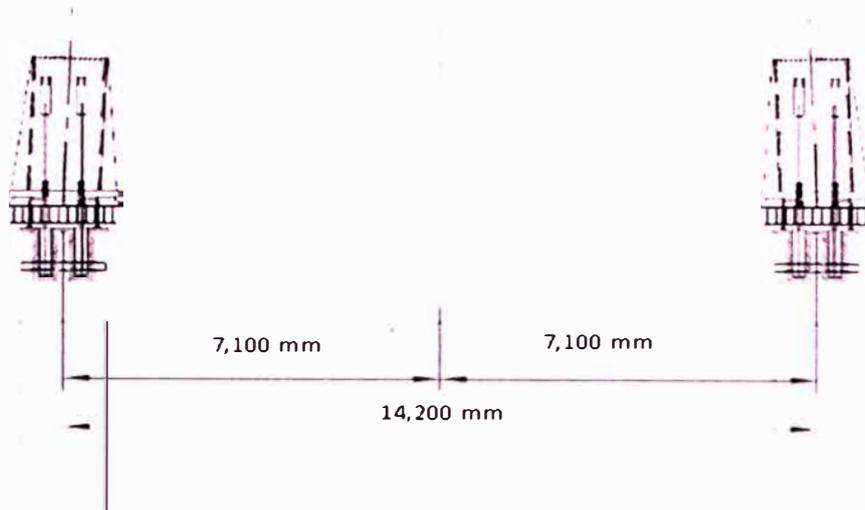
ESQUEMA DE ARMADO DE PILONES
